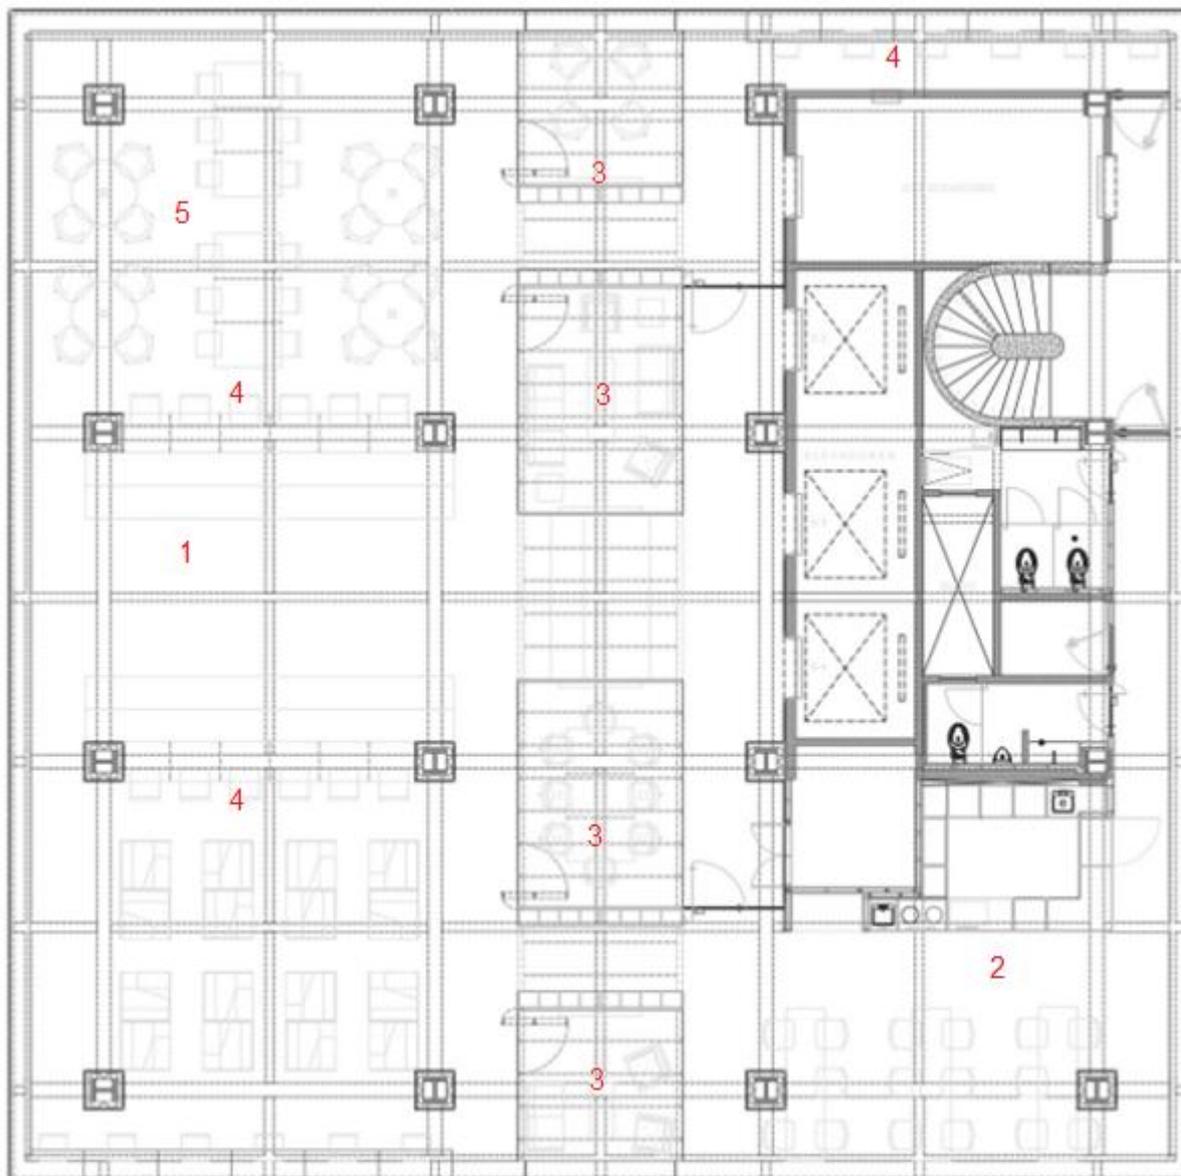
PLANTA DO PRIMEIRO PAVIMENTO (28º ANDAR) DO ARCHIELAGO
